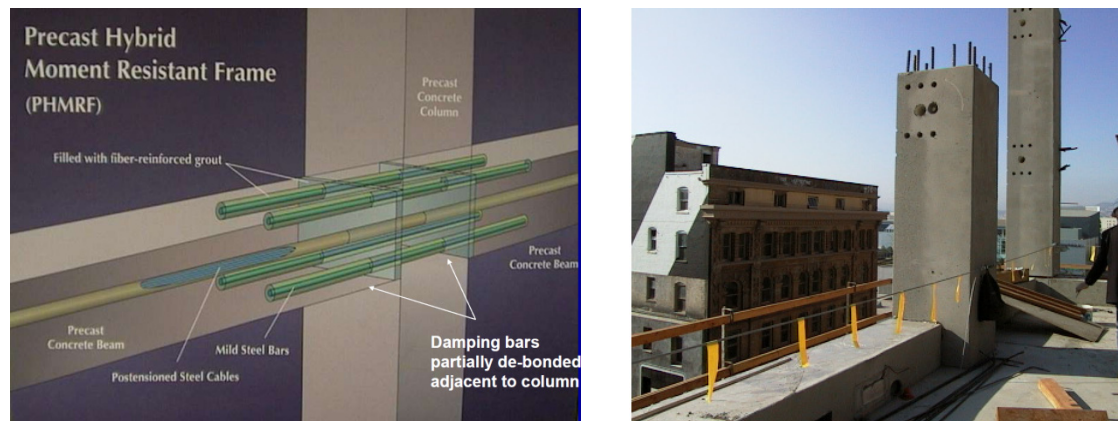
Sistema de ligação *hybrid frame connection*, utilizada na construção do *Paramount Building*, em São Francisco (Pampanin, 2011)
